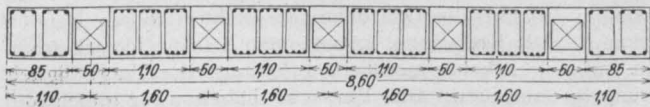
a. Scheitelschnitt mit Stellung der Pressen.
